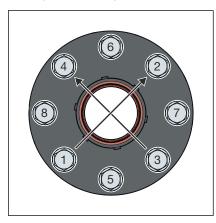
Profipress G XL Sechskantschrauben über Kreuz
